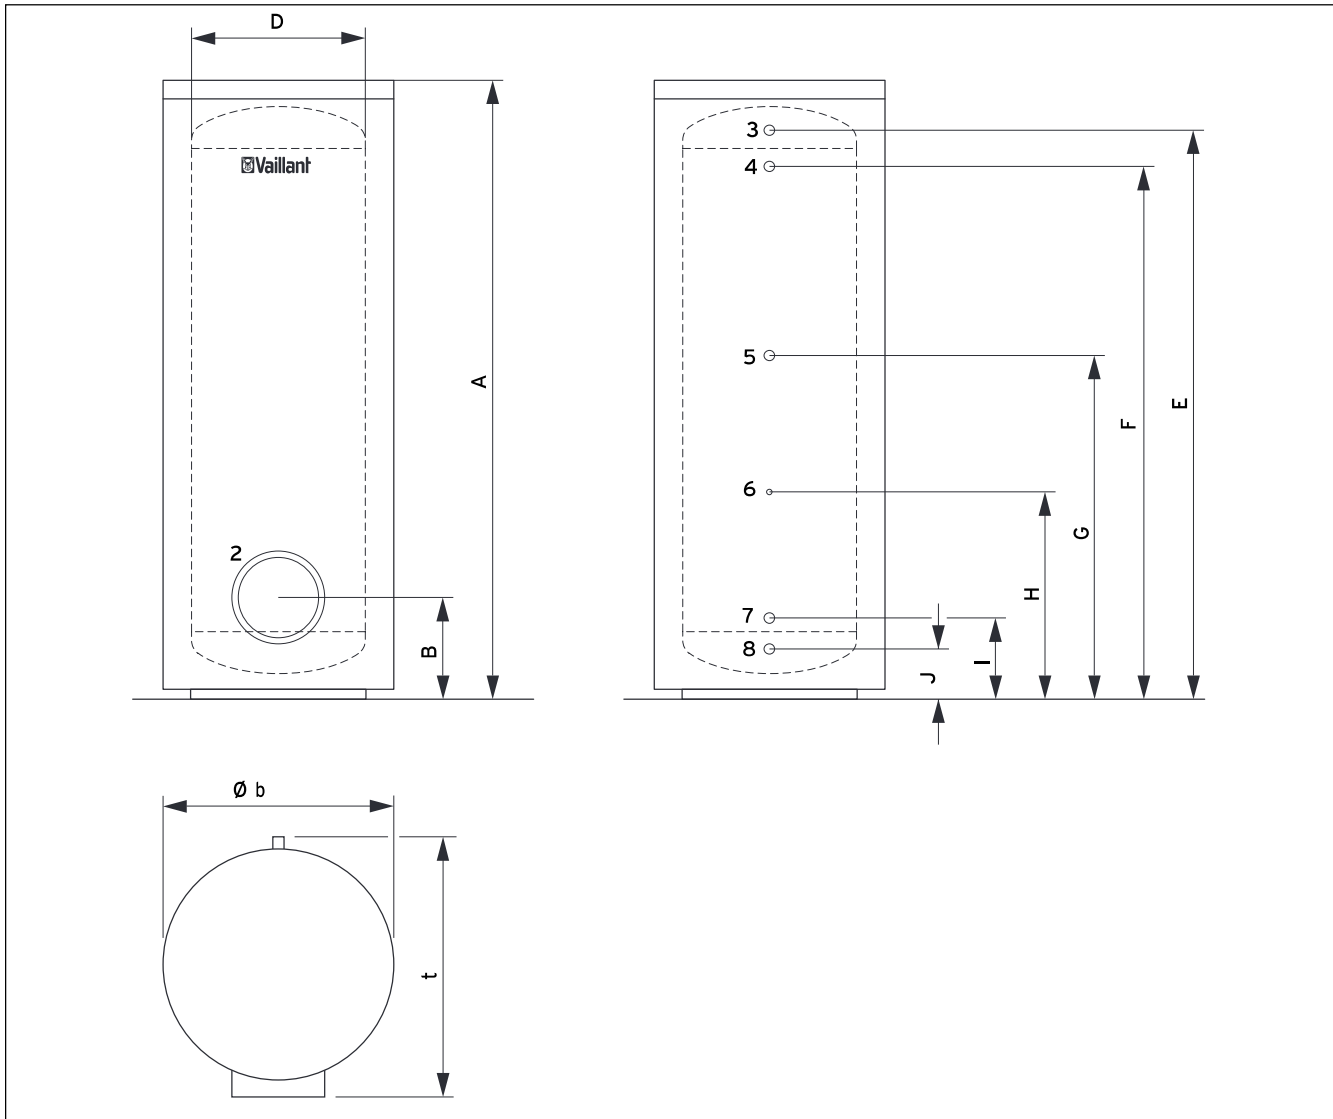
Dimensions de l'appareil et des raccords VIH RW
